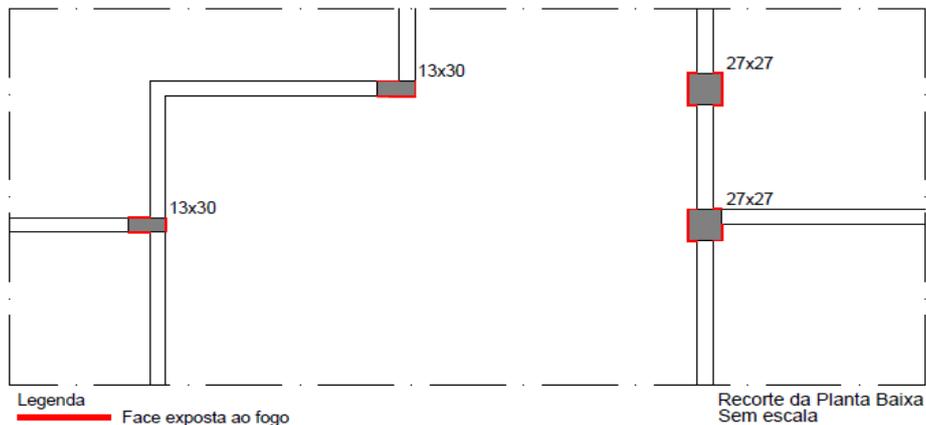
Pilar de concreto armado com uma face exposta ao fogo.
